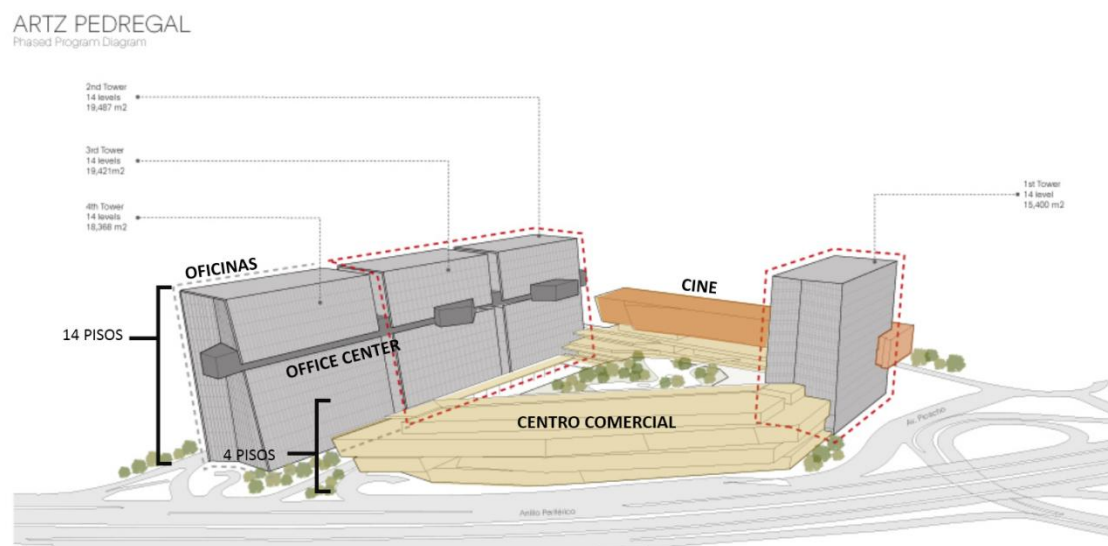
Esquema de volumetría. Elaboración propia y recuperado de: www.archdaily.com
